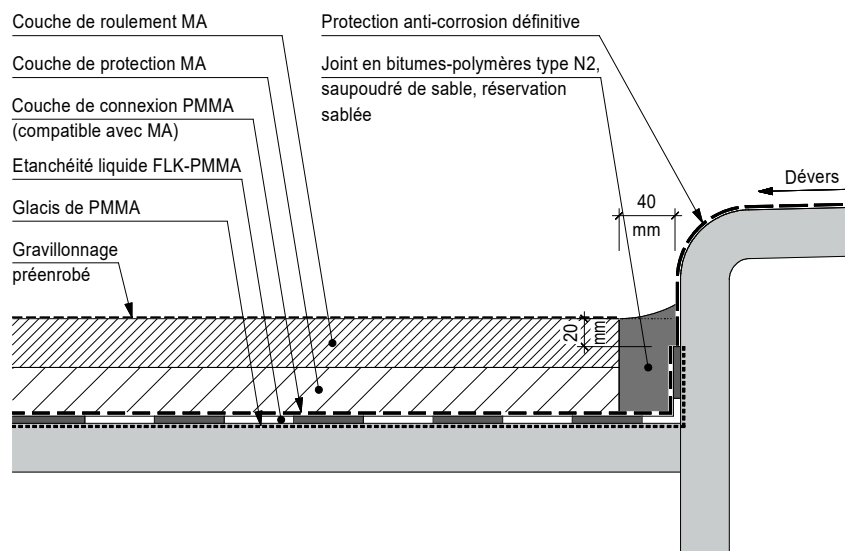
Système d'étanchéité FLK - Détail étanchéité contre bordure sur support métallique
